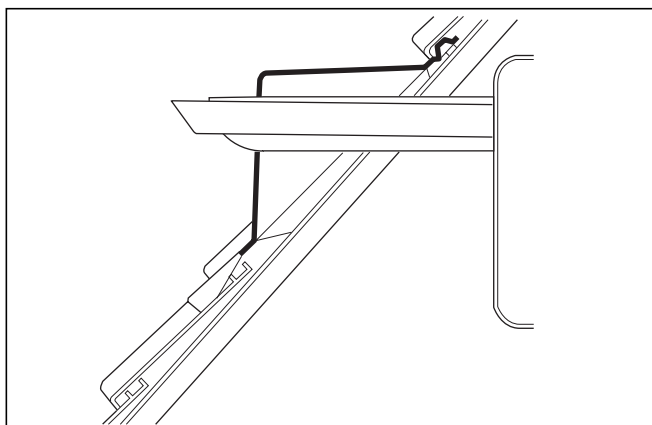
Пример монтажа горизонтального прохода через крышу (четырёхугольное слуховое окно)
